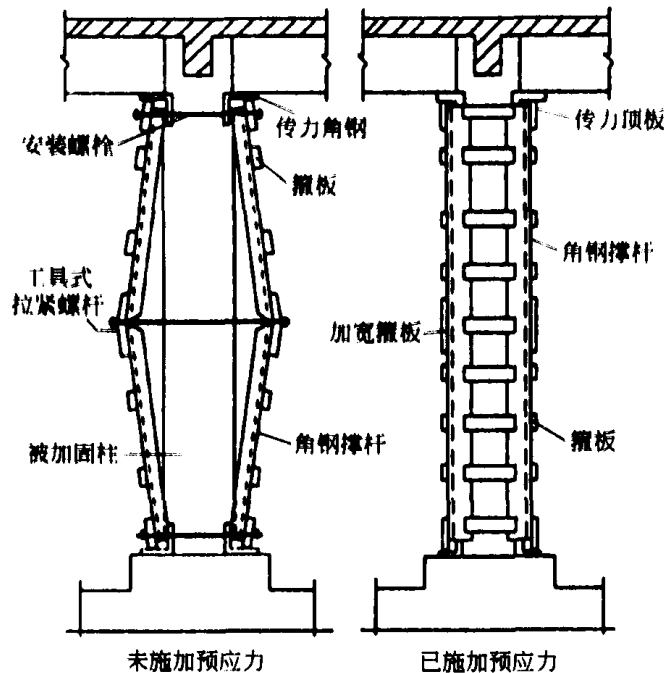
钢筋混凝土柱双侧预应力加固撑杆构造
